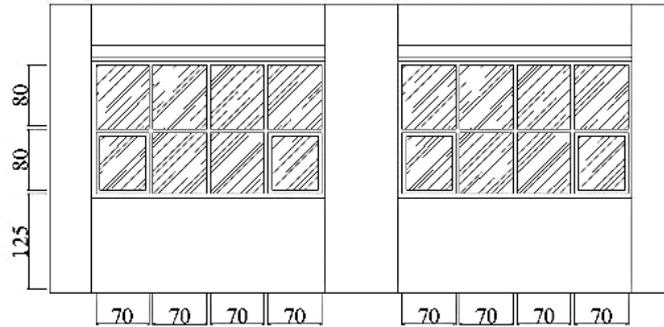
Alternatif 2 Tenggara Ruang dan Barat Laut Ruang IPA VIII
